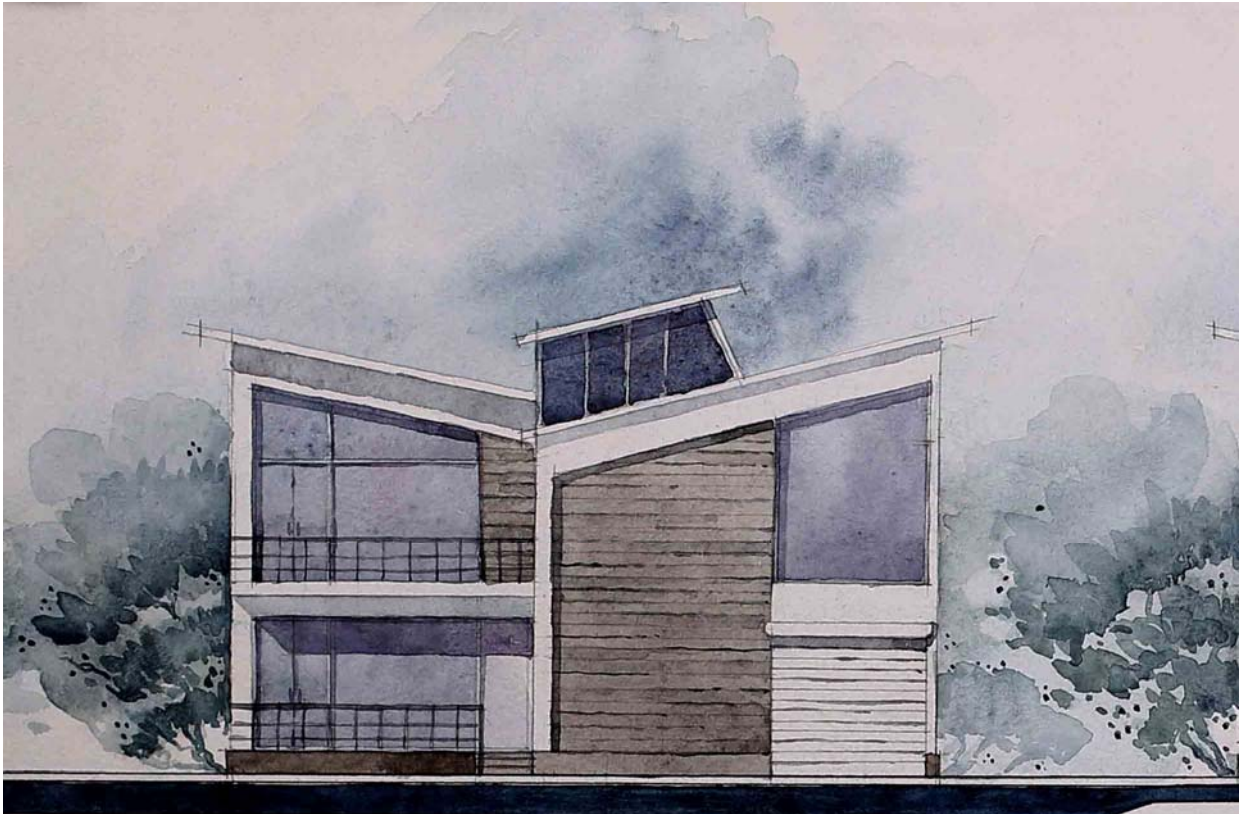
Проект 2-х этажного жилого дома. Фасад.
